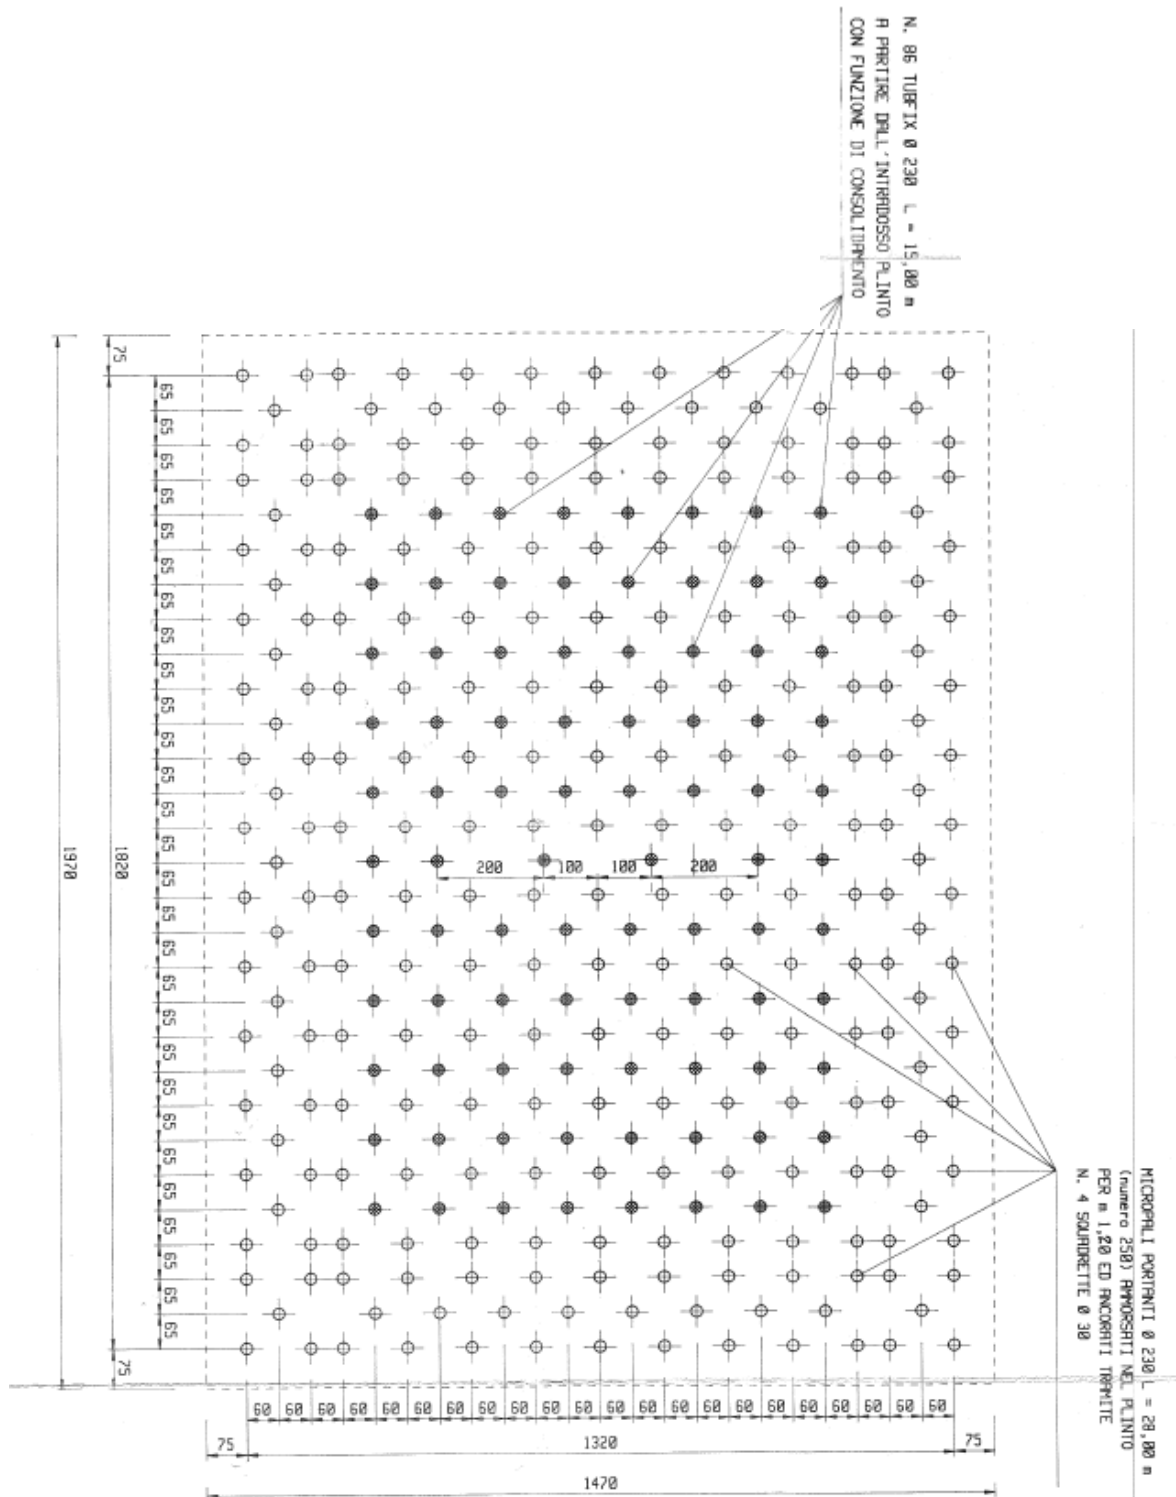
Pianta pile P21÷P22 su fondazione diretta con 250 micropali
